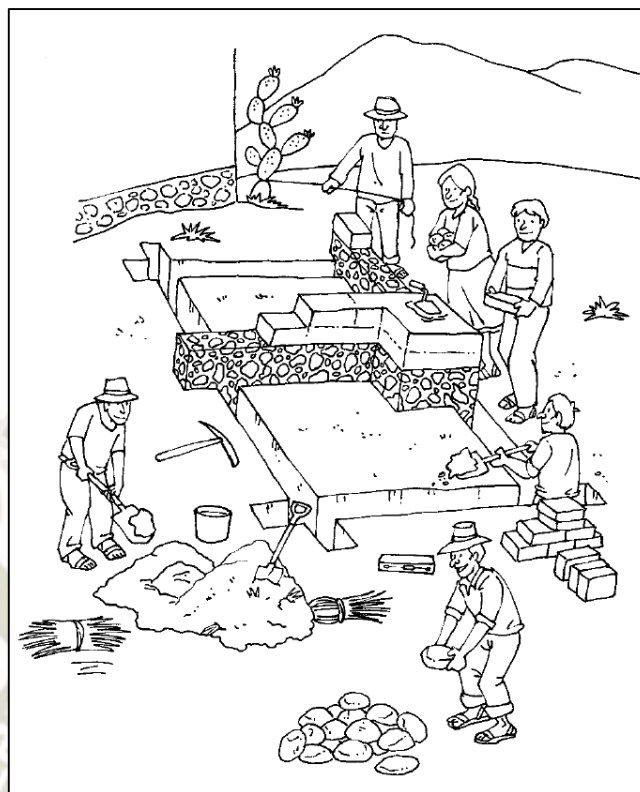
Cimentación y sobre-cimentación. Fuente: (Salud Sin Límites, 2009).
